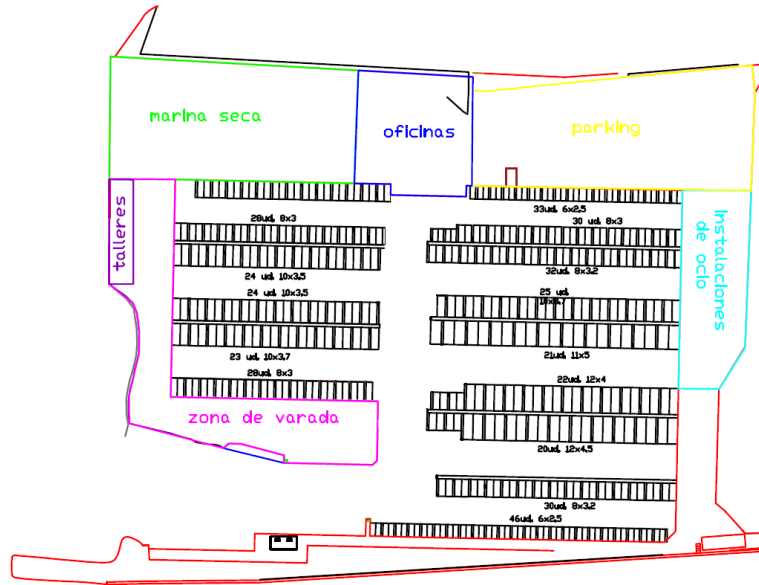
Diseño en planta alternativa 1. Fuente: propia.
